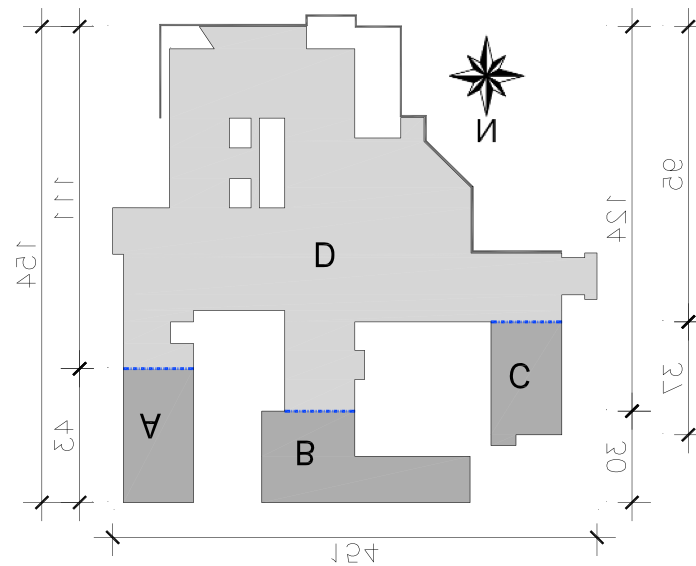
Representação esquemática em planta da separação em blocos do edifício. [8]
